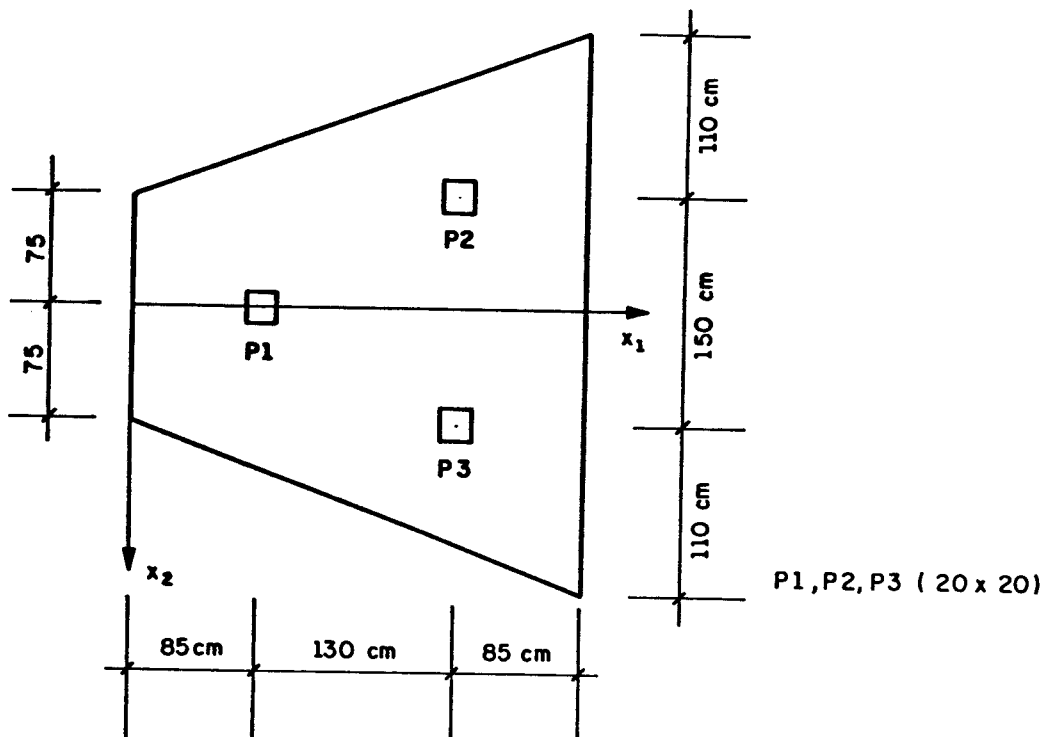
Sapata associada solicitada por cargas provenientes de 3 pilares.
